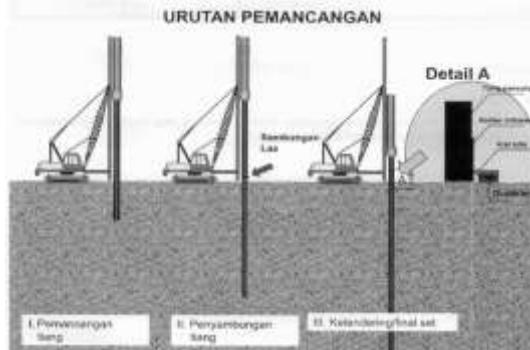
a Tiang pancang *Precast Prestressed Concrete Pile
